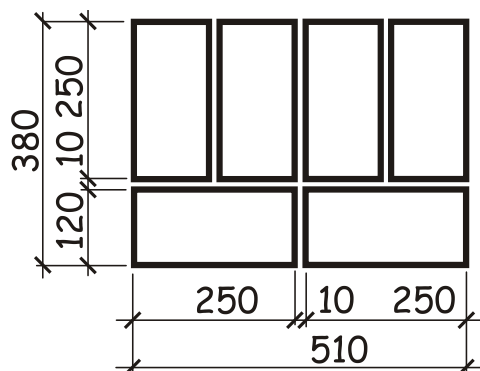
Приклад зображення поперечного перерізу стовпа
